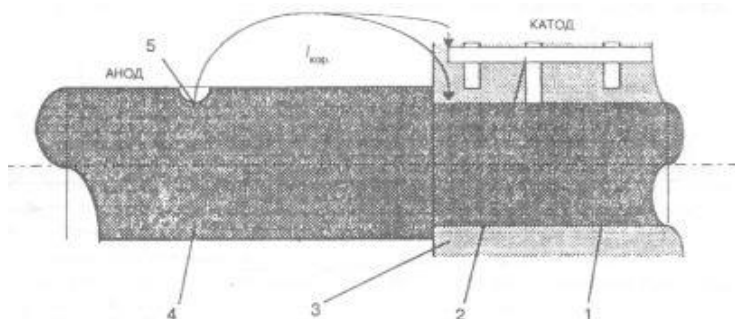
Коррозия труб, проходящих через железобетонные фундаменты: 1 – металлическая труба, 2 – железная арматура, 3 – бетонный фундамент, 4 – изоляционное покрытие, 5 – дефект в изоляции трубопровода
